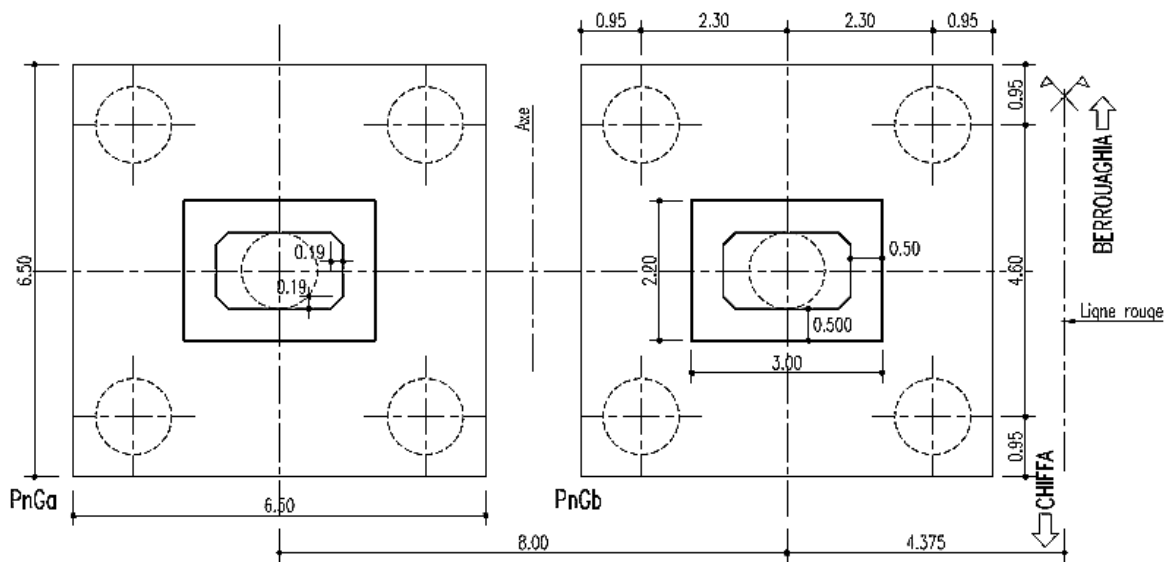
Dimensionnement de fût des piles élancées (une coupe sur semelle de fondation)
